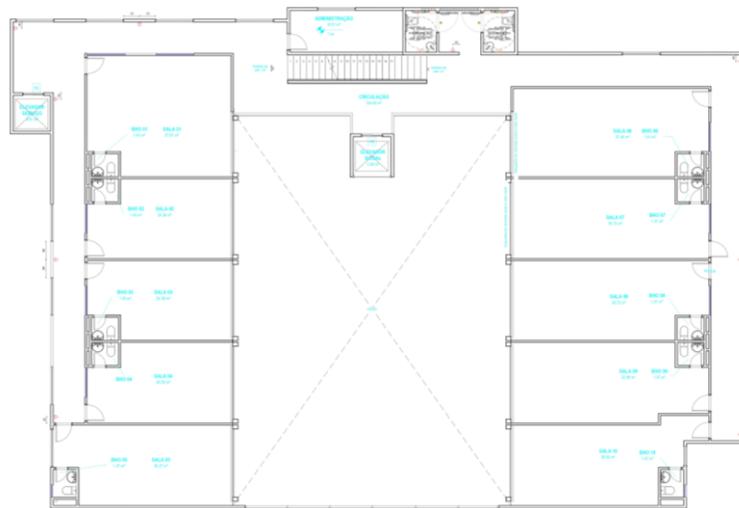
Planta de layout do 1º pavimento do Mossoró Mall.
